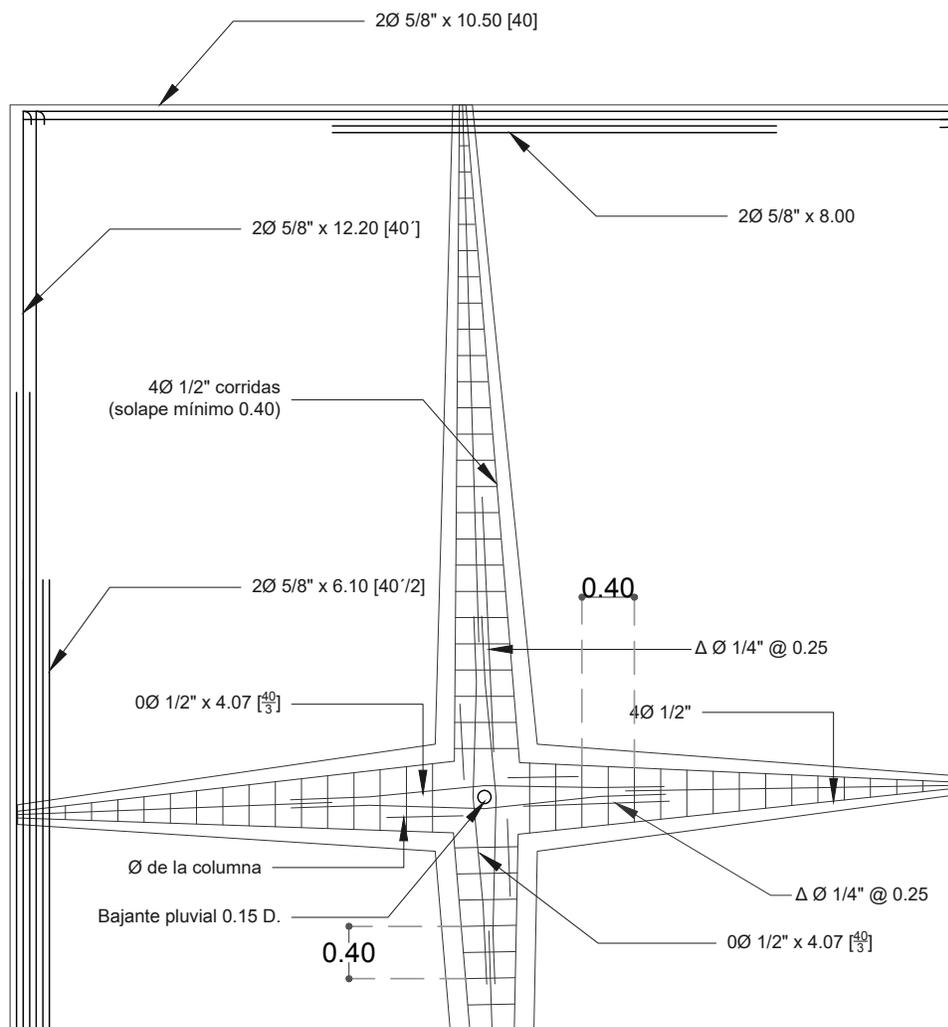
Detalle estructural de columna y B.A.P. paraguas invertido, edificio industrial Bacardi, Fondo Félix Candela, *op. cit.
